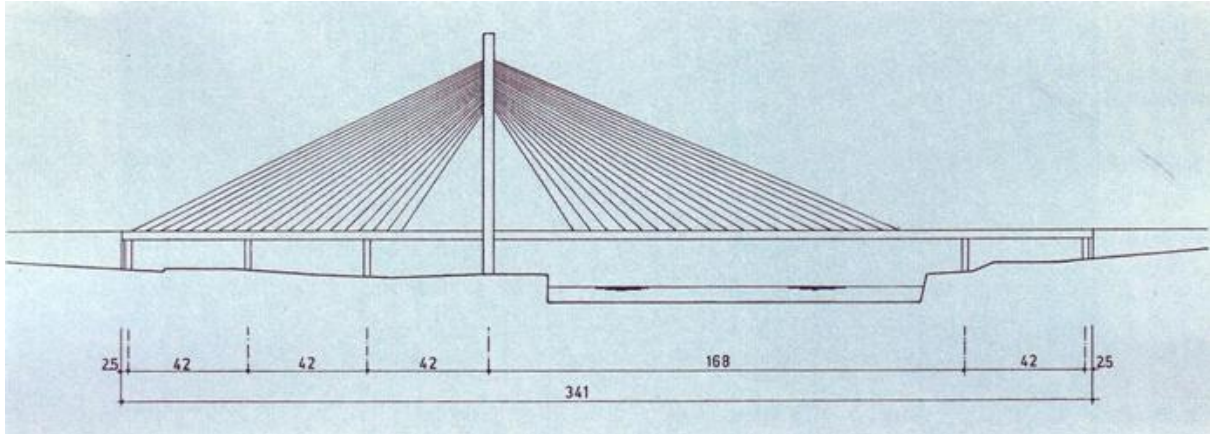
PLAN DU PONT PÈRE PIRE
